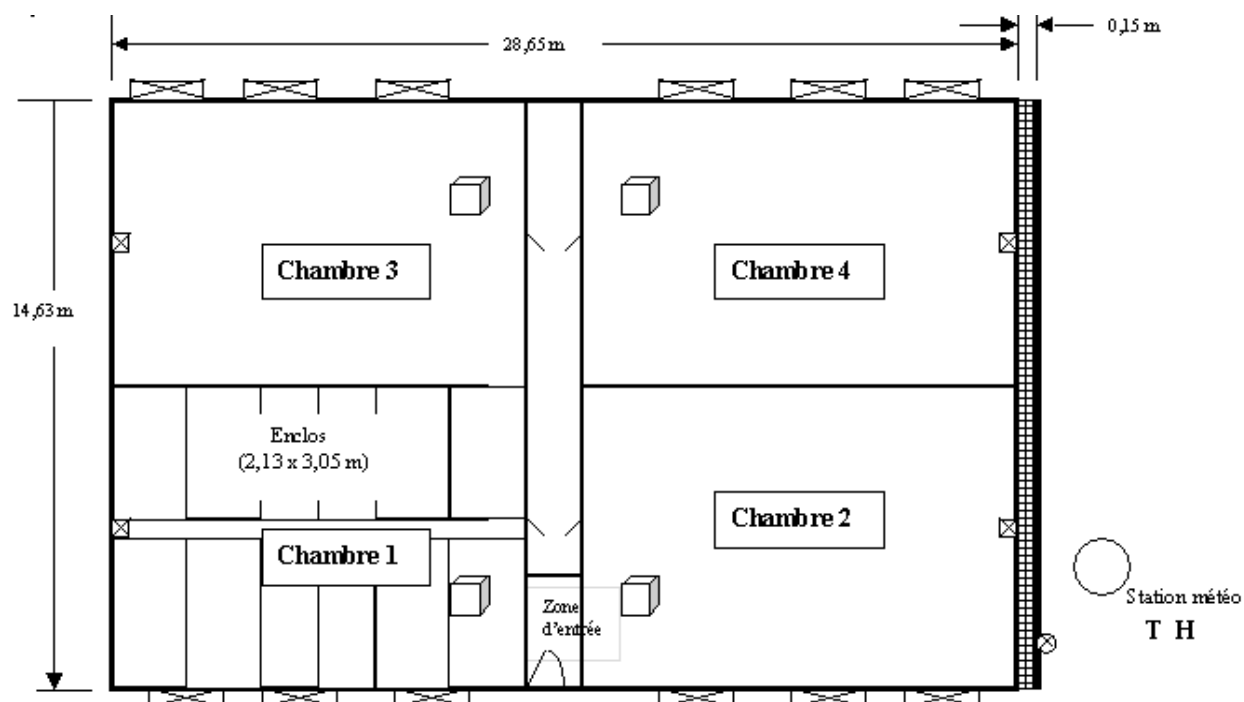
Plan de plancher de la pouponnière de la ferme Marisol
